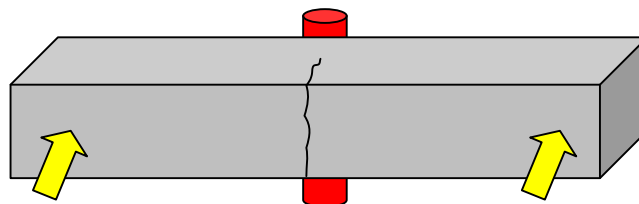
ひび割れ状況(C023 試験体) (鉄筋引張応力度  $140\text{N/mm}^2$  導入試験体)
